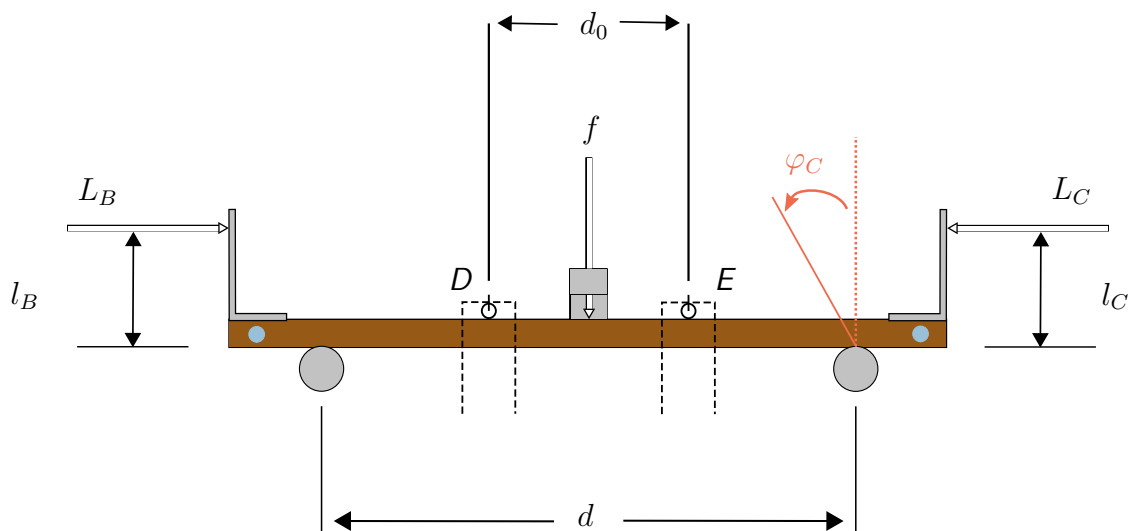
Schéma du bâti de fluage : zoom sur la poutre
